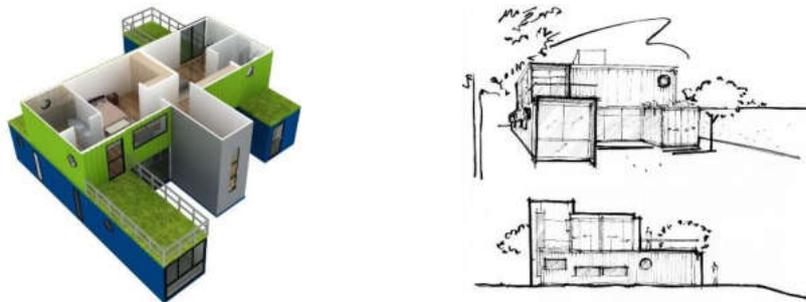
e 20: Elevação em 3D e croqui. Fonte: ArchDaily, 2016.
